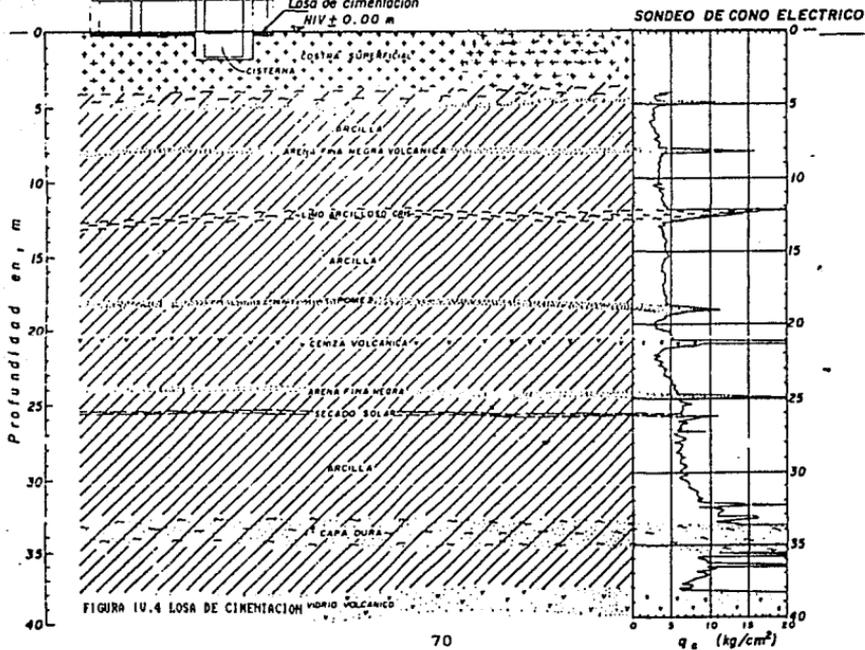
LOSA DE CIMENTACION VIDRIO VOLCANICO
